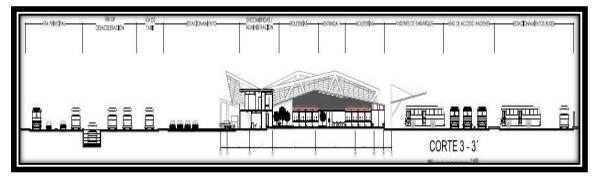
Planos del Terminal Tipo 3 para el cantón Archidona (Vista Lateral 3) Fuente: (Túqueres, 2017).
